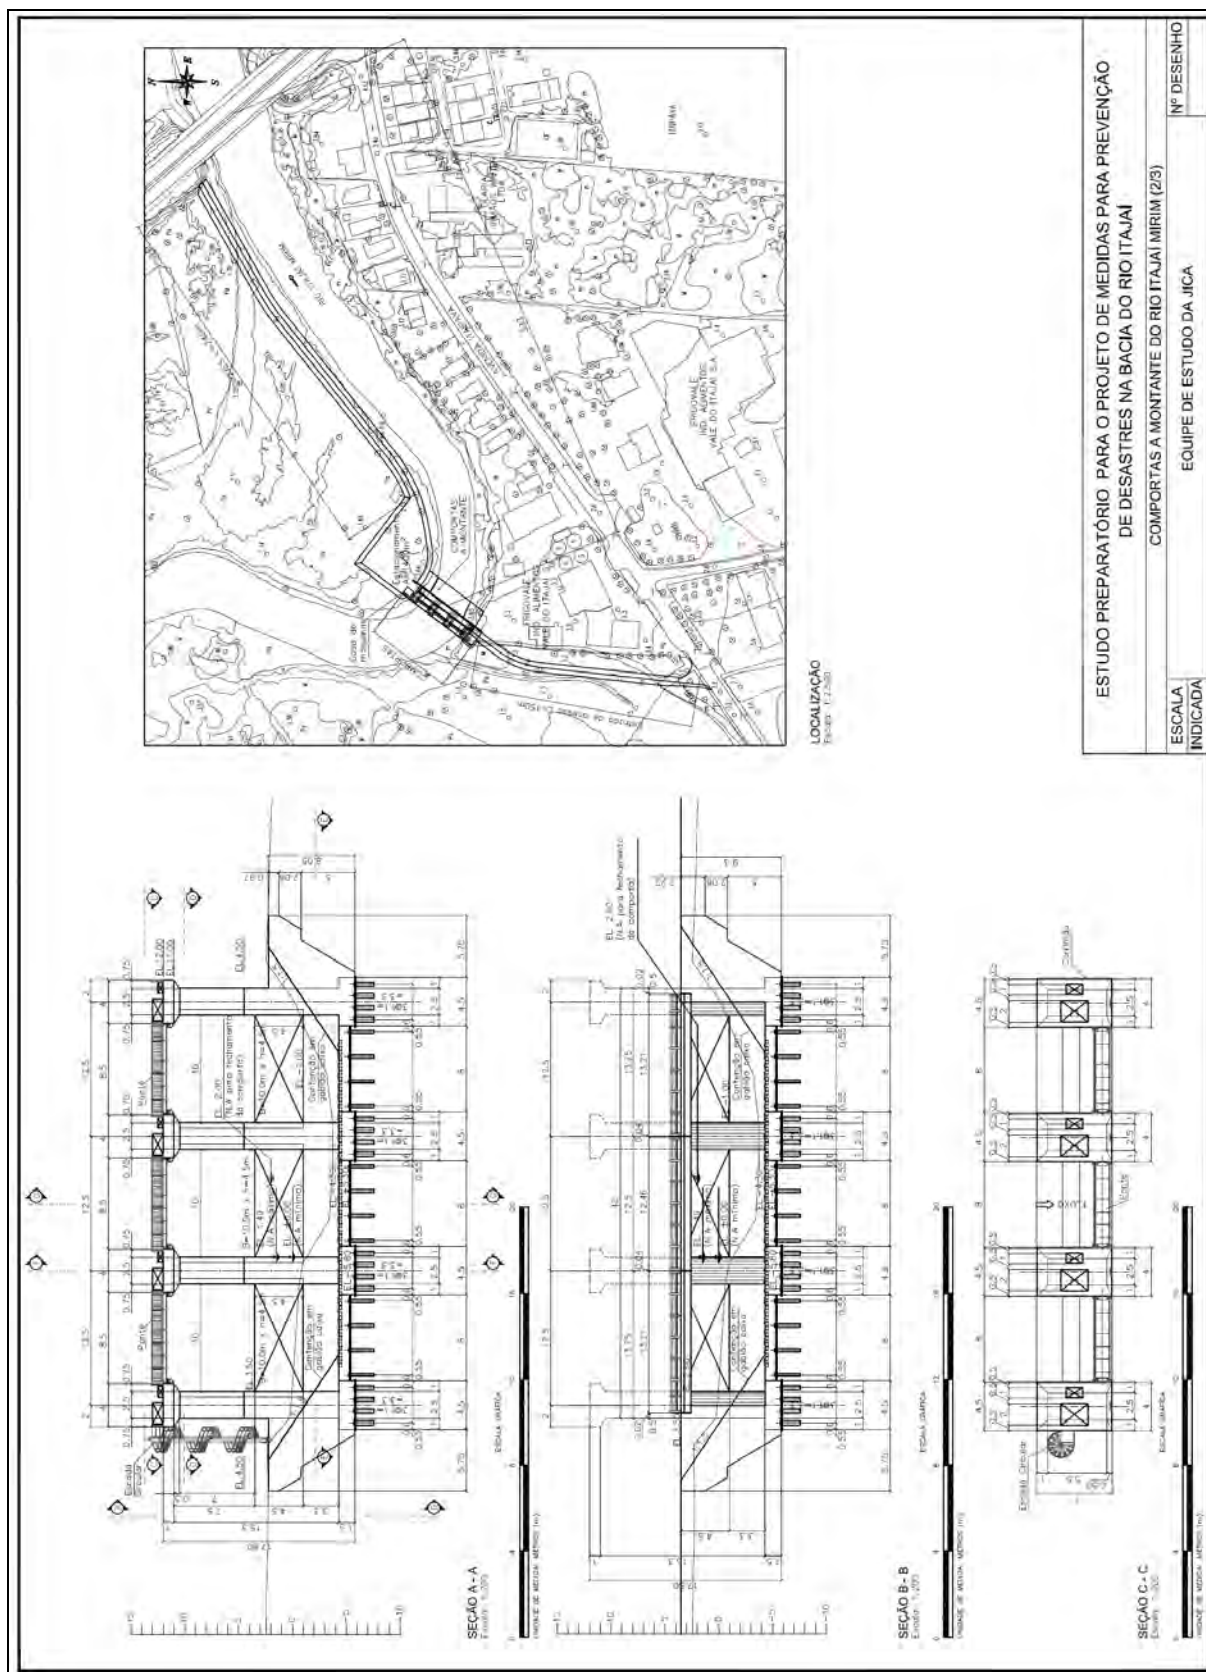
Planta Geral da Comporta à Montante (2/2)
